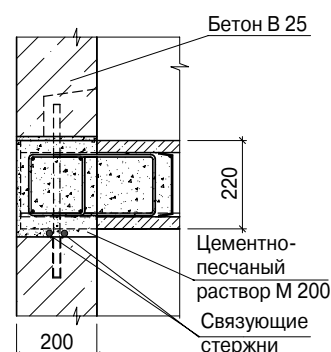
Пример соединения плит перекрытия с межпустотными усилителями с панелями наружных стен
